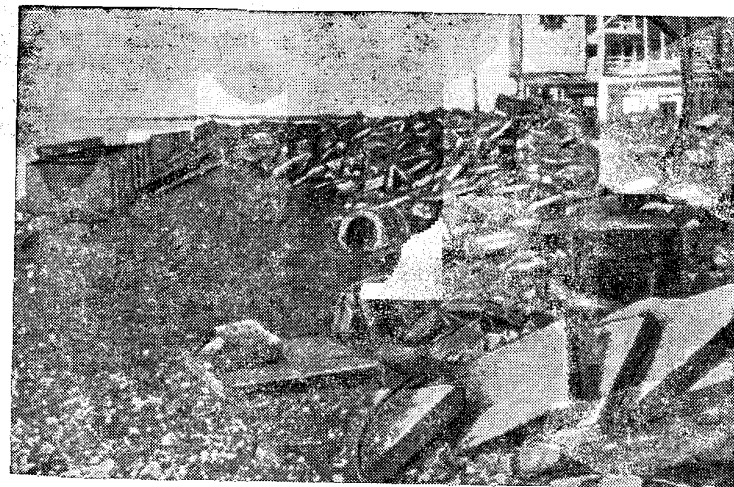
Разрушение береговой стенки и набережной Пицунды февральским штормом 1969 г. (по С. Л. Вендрову, В. П. Зенковичу).
